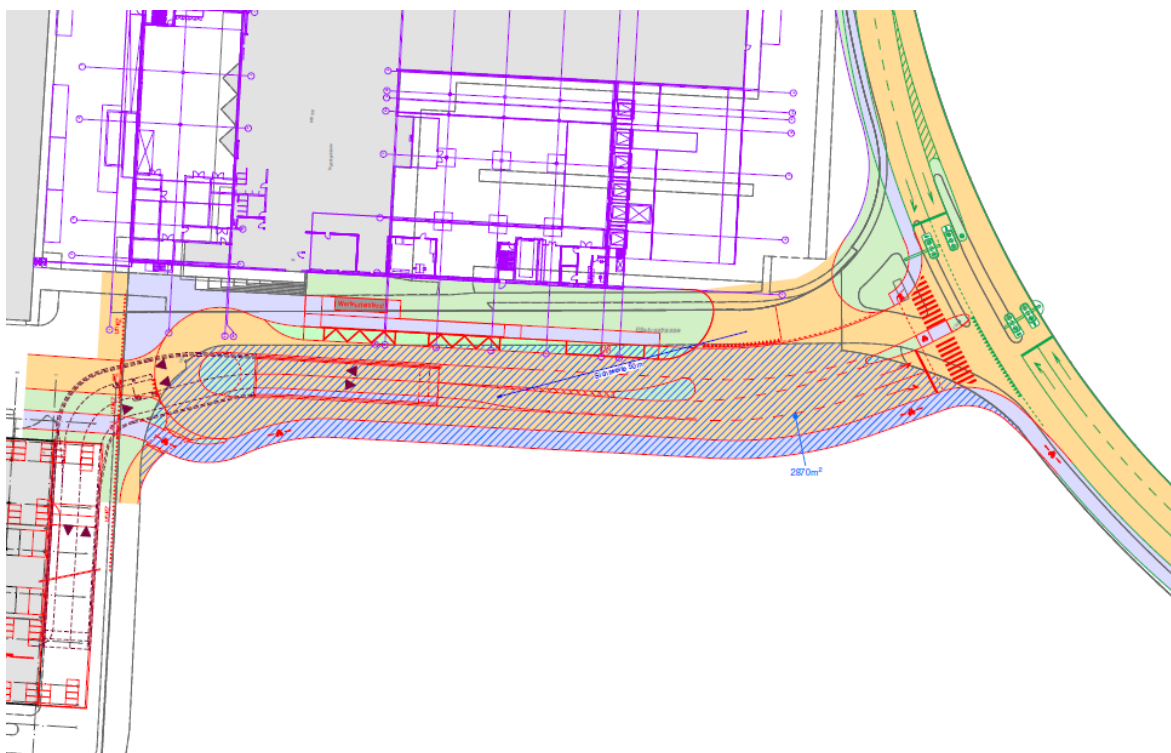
Ausschnitt Situationsplan Ausbau Pilatusstrasse (© Wälli AG)
